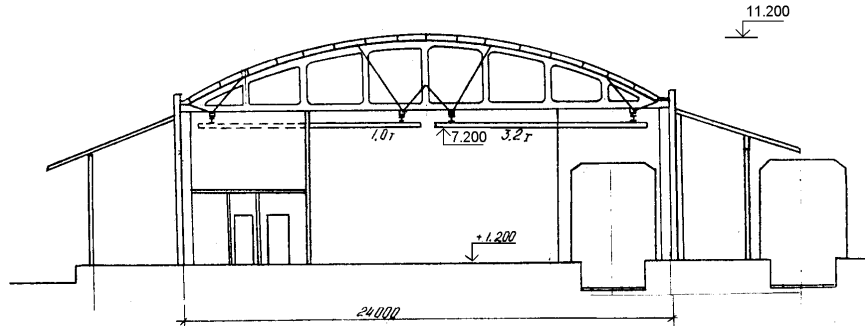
Разработка Харьковметропроекта– покрытие из железобетонных плит по фермам
